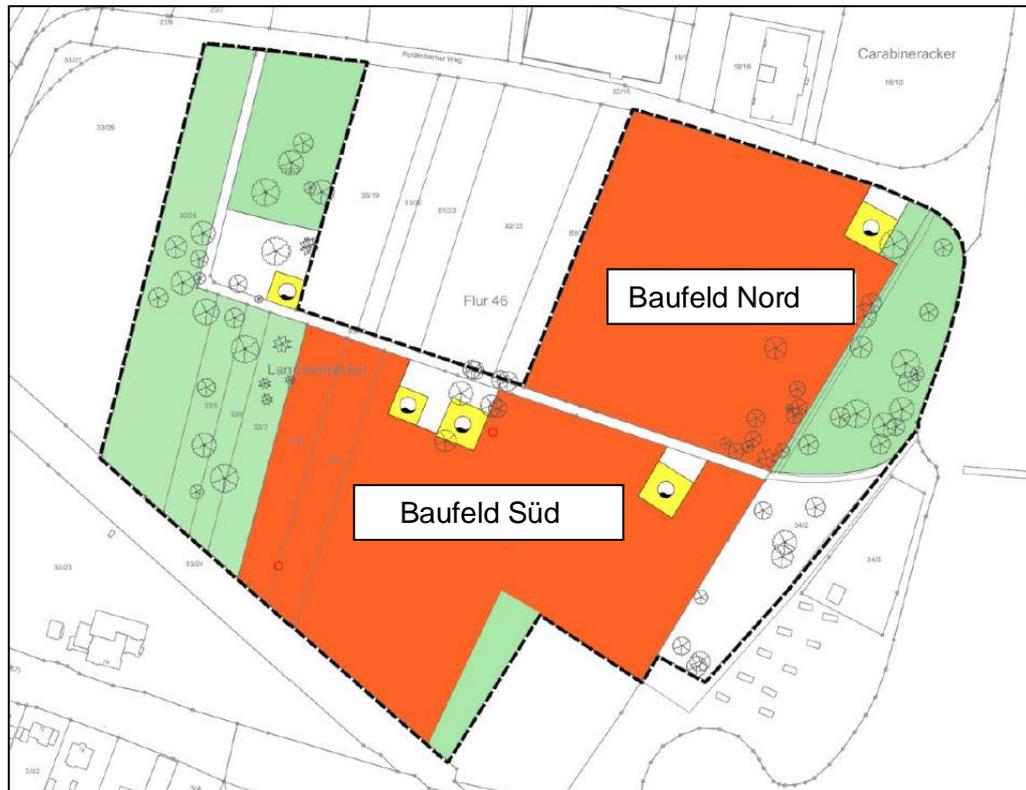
Planungsraum mit den zwei geplanten Bauabschnitten
